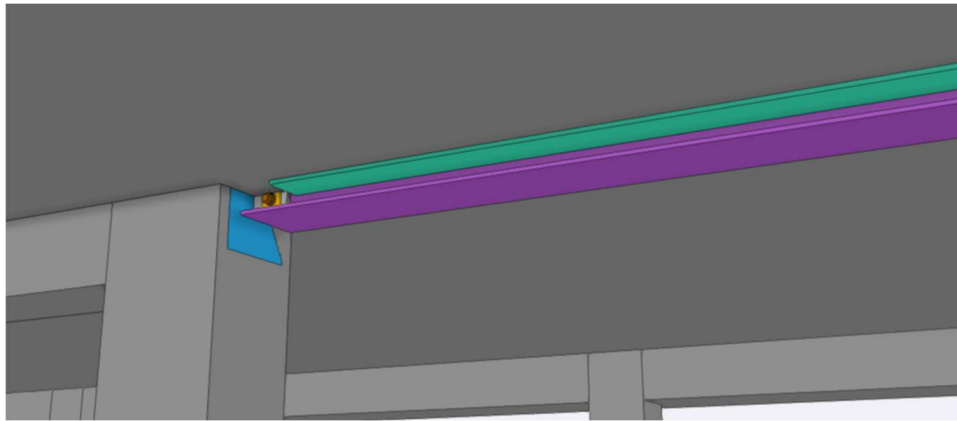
Viga ligada ao Betão 2 (Fonte: Software Tekla, 2023)
